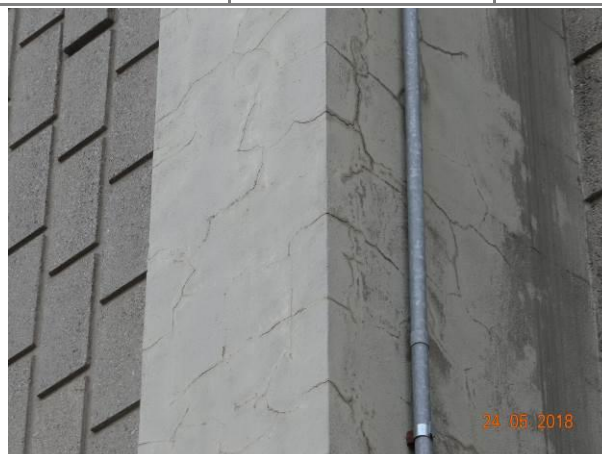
Fissuras aleatórias na face Sul do pilar P1.
